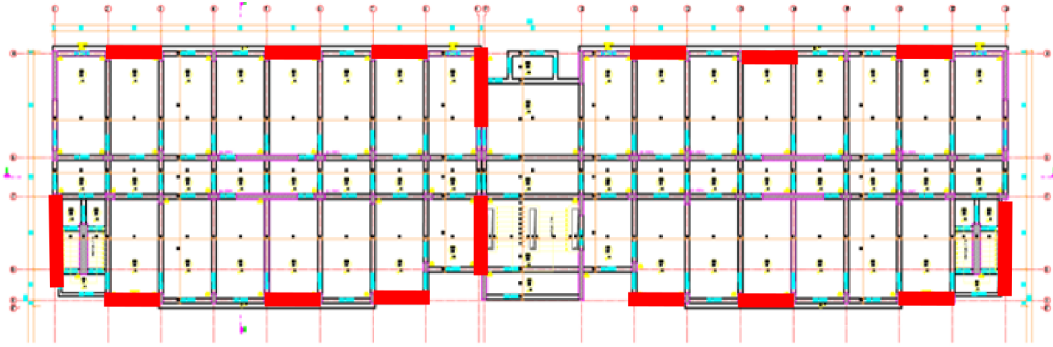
'de örnek yapısal kalıp planı sunulan yapıda tespit edilen zafiyetler;
